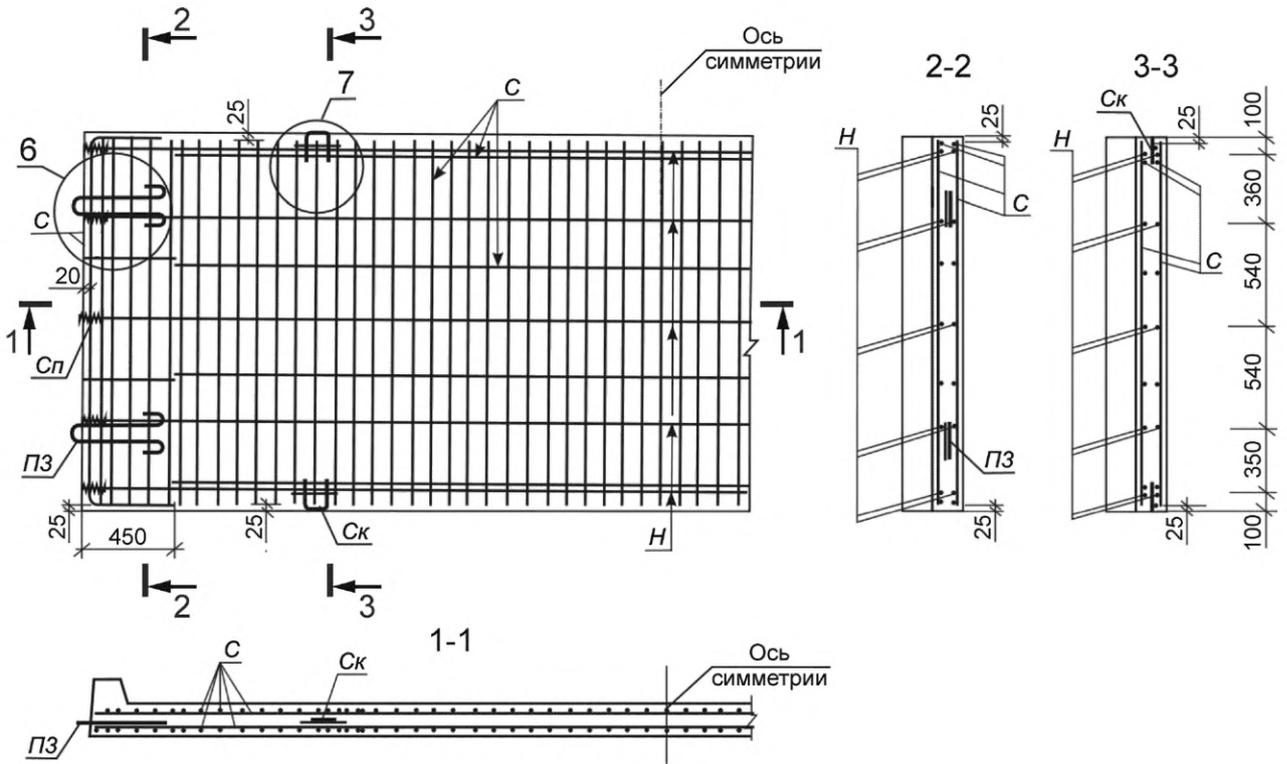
Схема армирования плиты ПБ55.20
